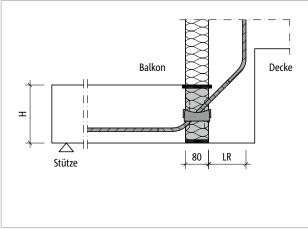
Schöck Isokorb® T Typ QL-WO: Balkon mit Höhenversatz nach unten und Außendämmung
